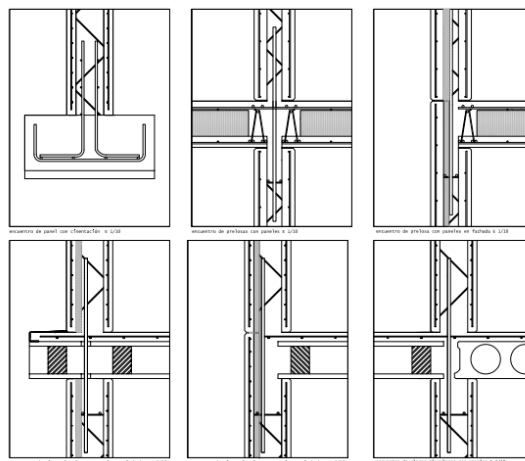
Conexiones del Sistema Constructivo “arquitectura vertida”. Fuente: POSTELÉCTRICA FABRICACIÓN S.A, España.
